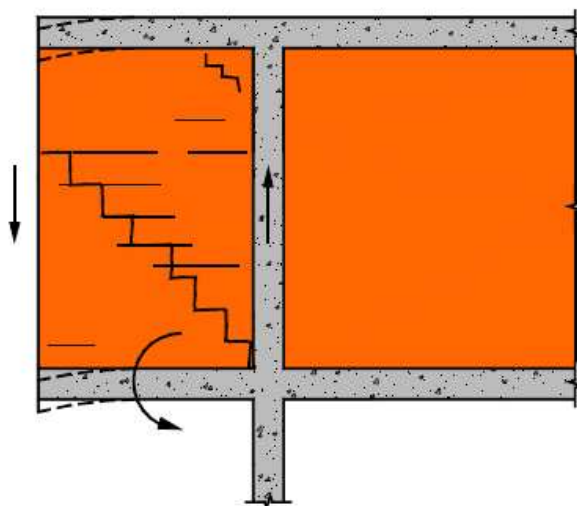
Fissuração devida à deformação de consolas.[10]
